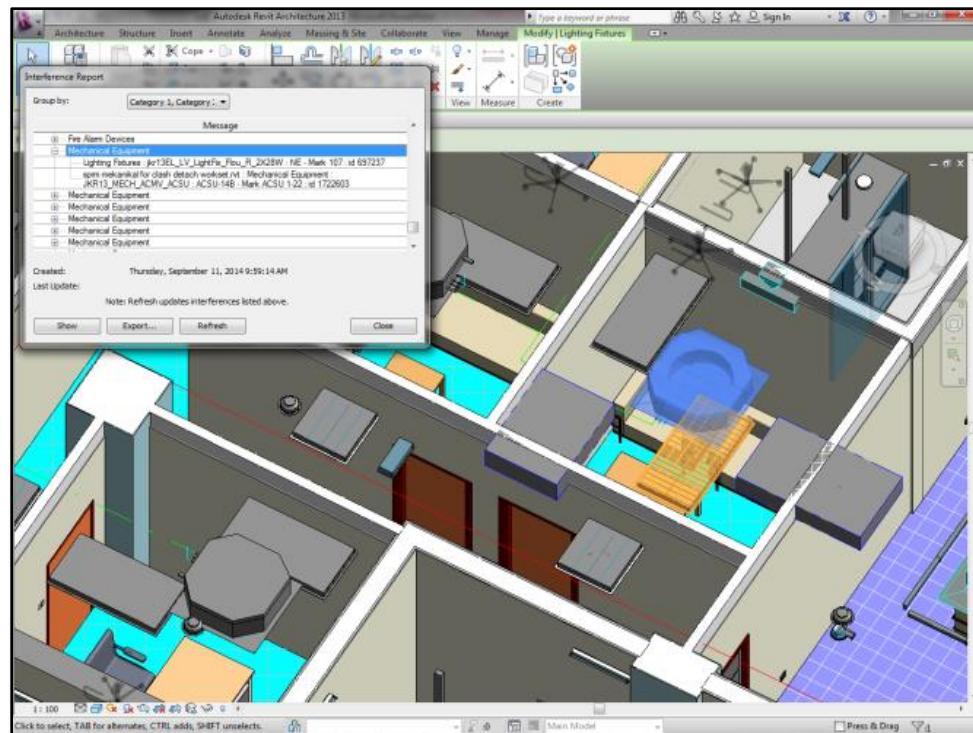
Ketinggian minimum di antara aras lantai dan siling dapat disemak
